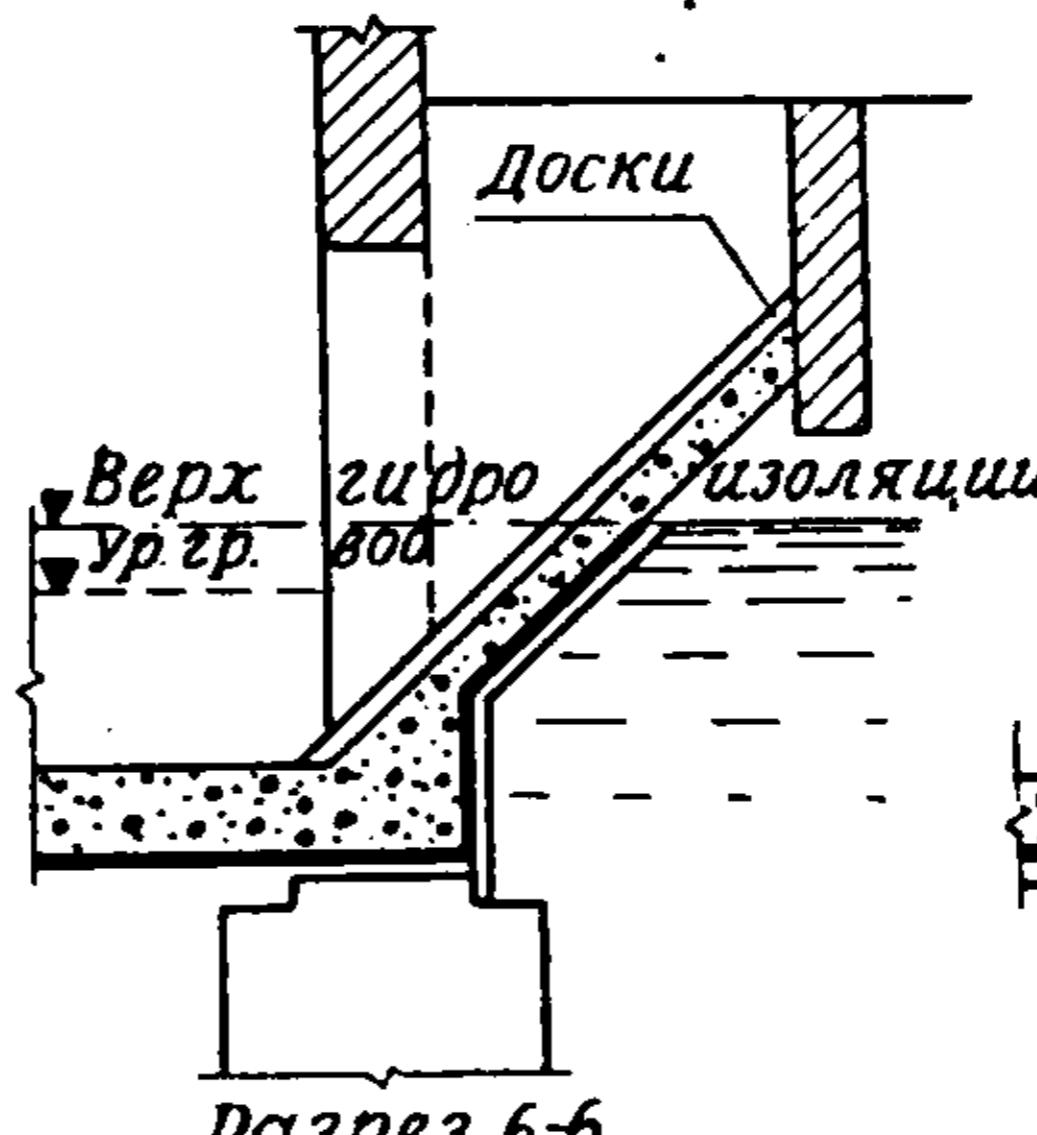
Вариант 2. Изоляция у трубы. Боров прямой. Необходимы водонепроницаемые швы. Не рекомендуется.
